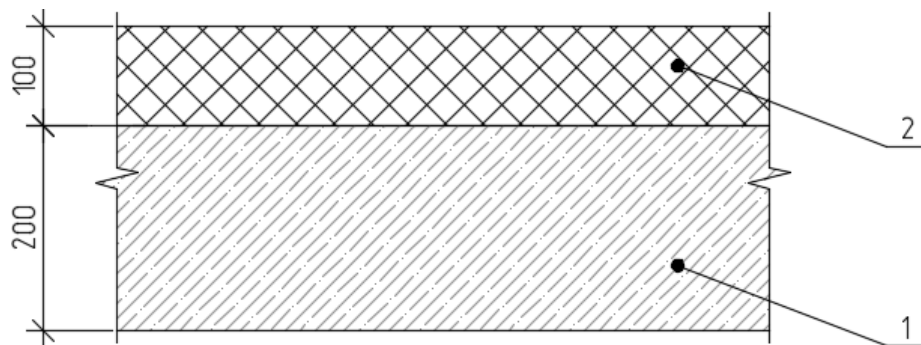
Схема ограждающей конструкции перекрытия
